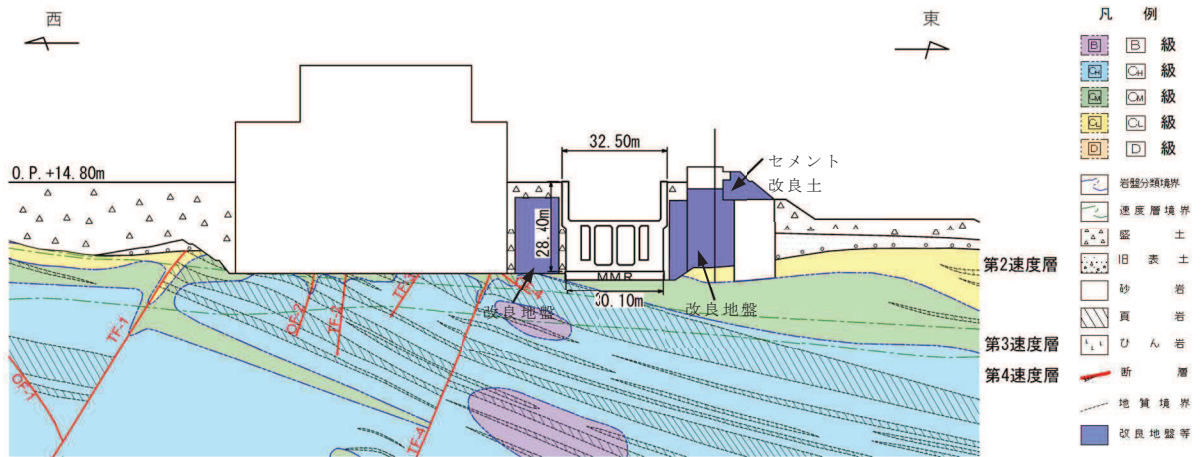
海水ポンプ室の地質断面図 (⑭-⑭断面)
